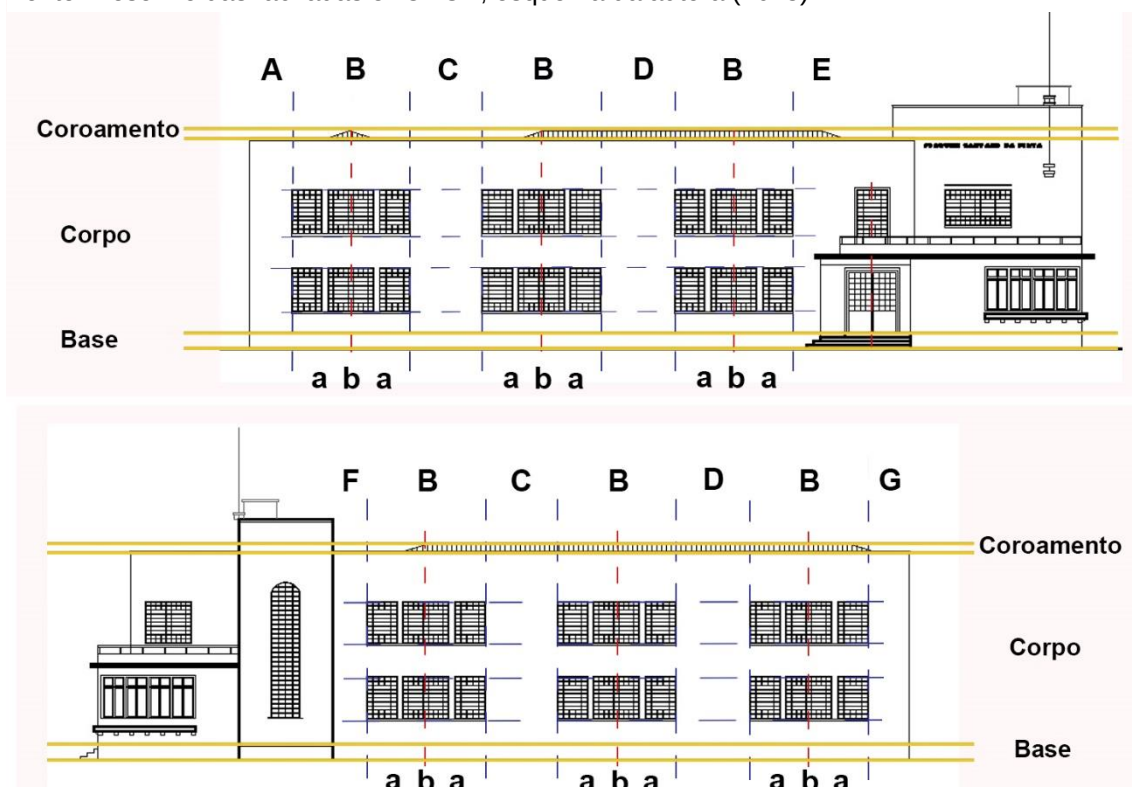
Fachadas Sudeste e Sudoeste E.E.E.F. Joaquim Caetano da Silva, indicando a distribuição das esquadrias e a marcação horizontal da edificação.
